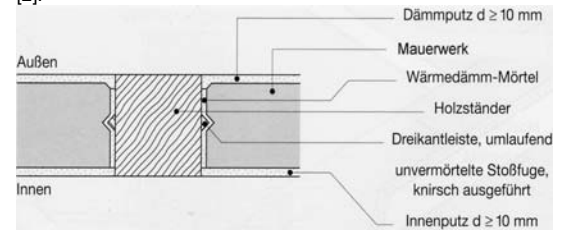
Anschluss von Mauerwerksausfachungen an einen tragenden Fachwerkposten, aus [2].
